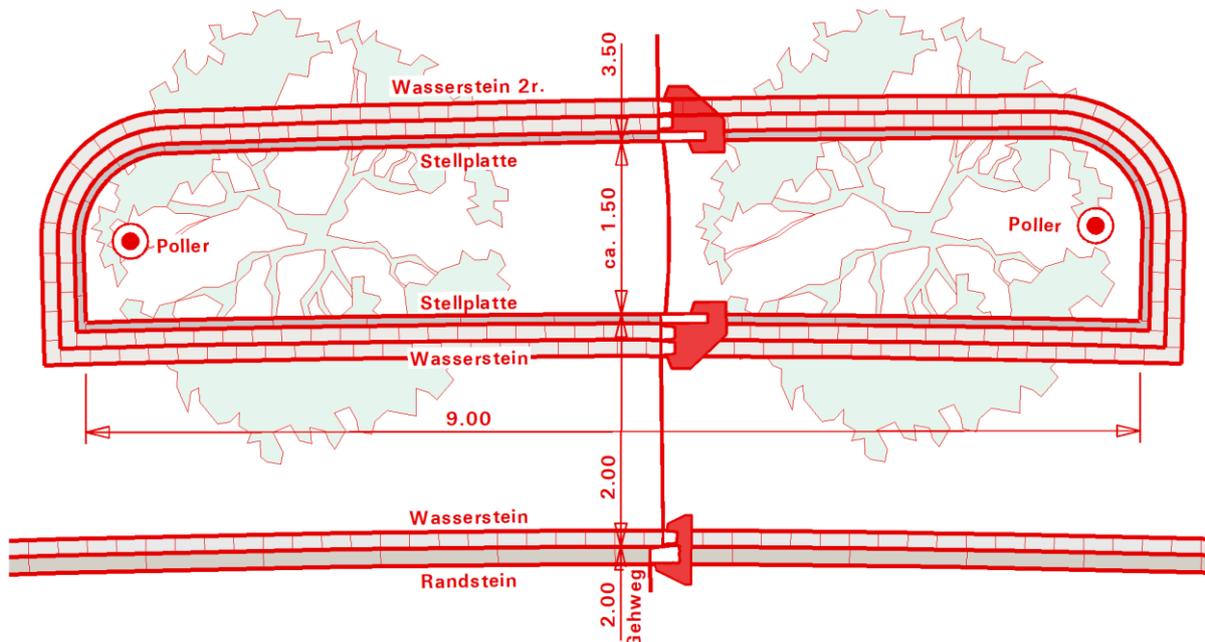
Schema Baumgrube aus Situationsplan Nr. 31.1
